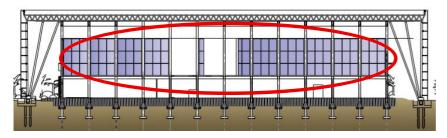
Konsep Supper Struktur 1 Bangunan
